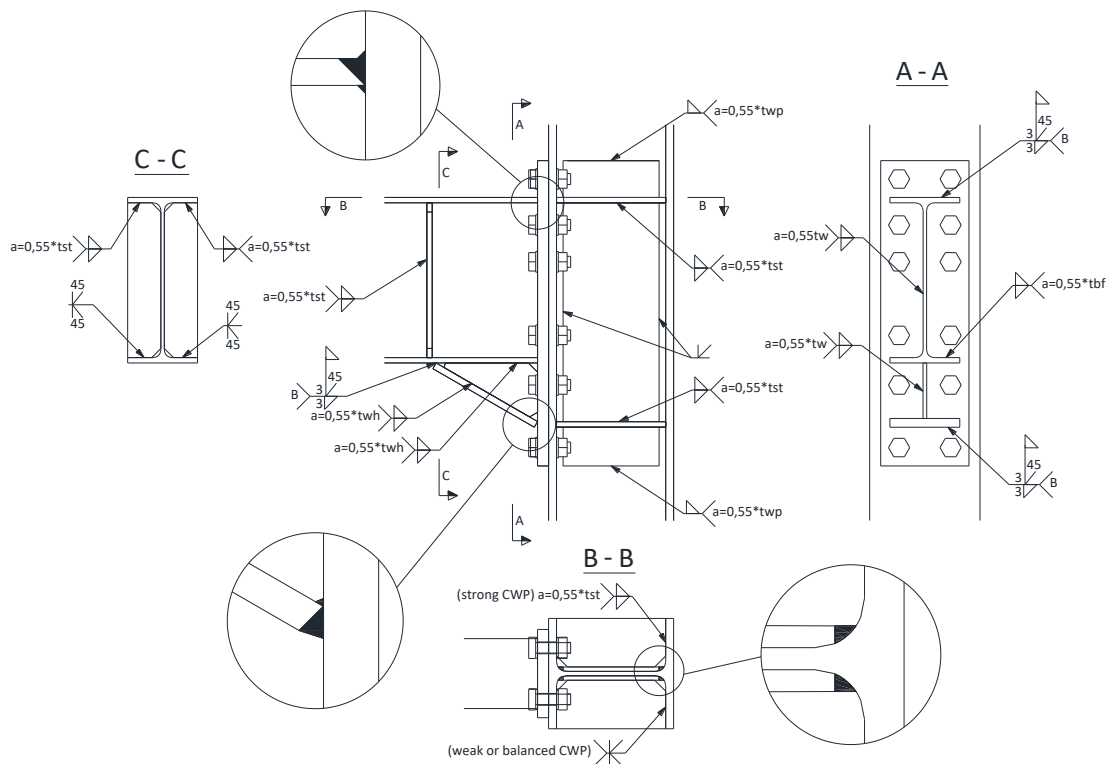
Detalhes de soldadura para as juntas com chapa de extremidade estendida e com esquadro de reforço.
